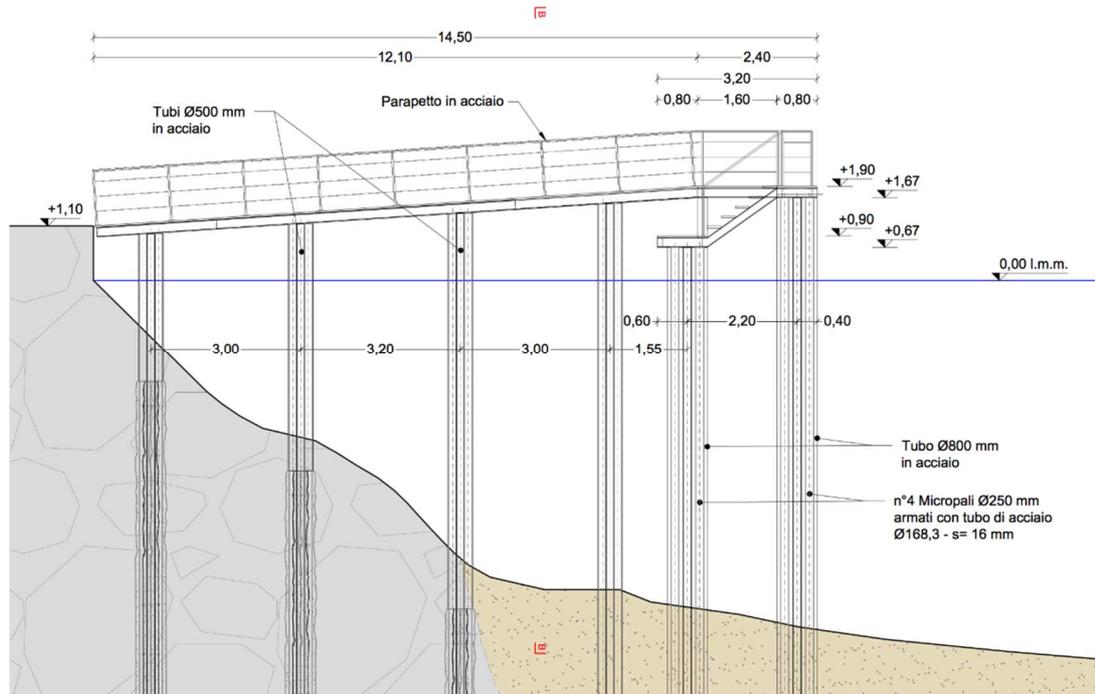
Ipotesi di struttura a giorno (Alternativa 3). Sezione verticale.
